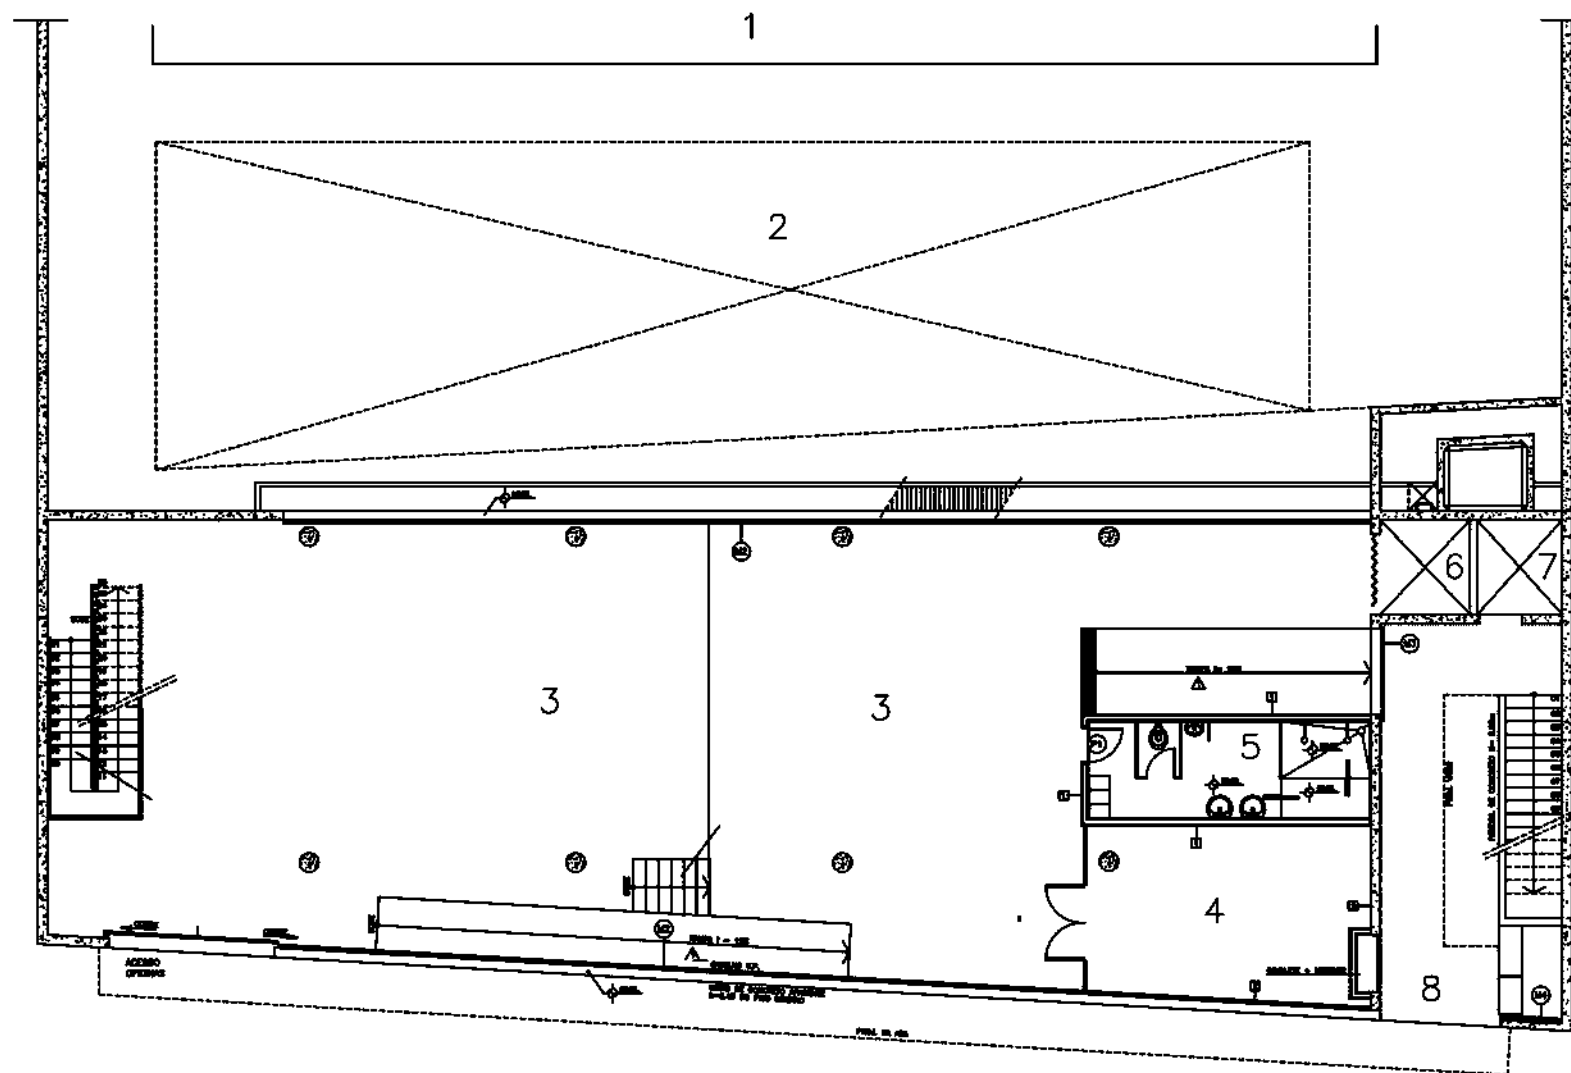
Planta do pavimento térreo do prédio novo (1. edificação existente; 2. vazio; 3. oficinas; 4. transformador; 5. vestiário; 6. monta-carga; 7. poço do elevador; 8. portaria). Fonte: Acervo Brasil Arquitetura.
